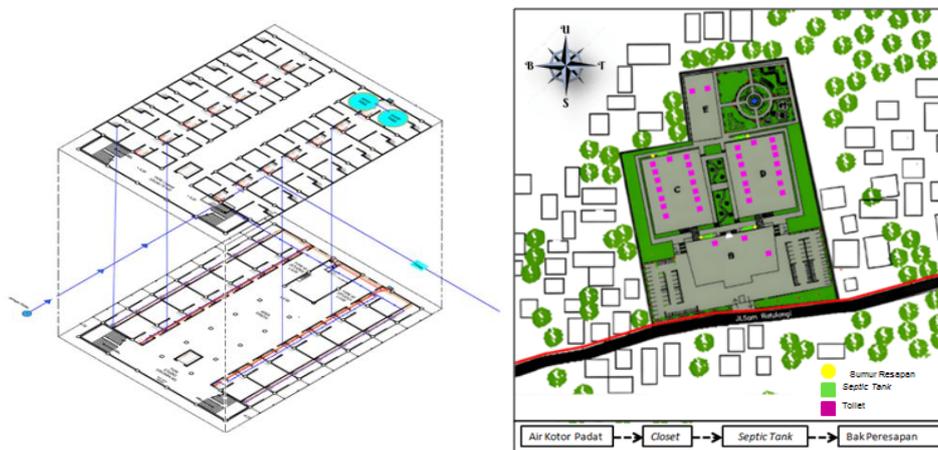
Konsep Sistem Instalasi Air Bersih Pada Site dan Bangunan
